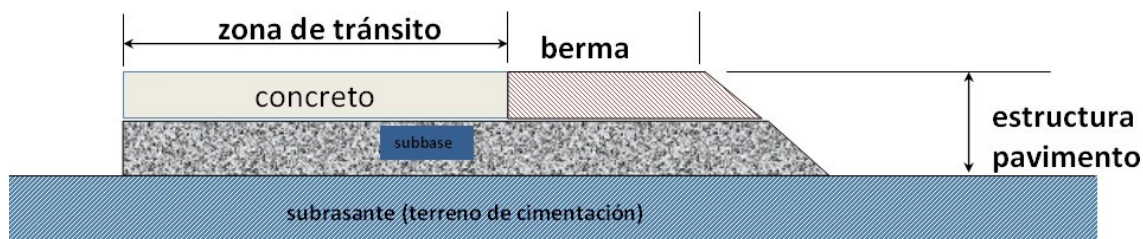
Estructura del pavimento rígido. Fuente: Becerra, M. (2012)
